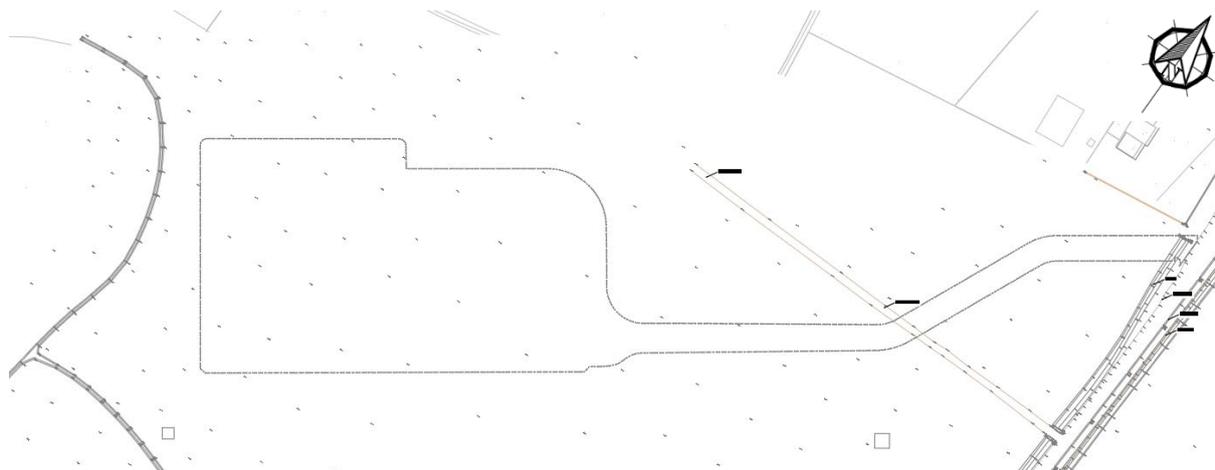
Estratto planimetrico dello stato di fatto – Individuazione dell'area oggetto di intervento con polilinea nera tratteggiata.
